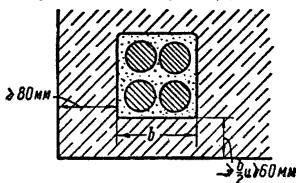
Защитный слой бетона до ближайшей поверхности канала, предназначенного для группового расположения пучковой или стержневой арматуры
